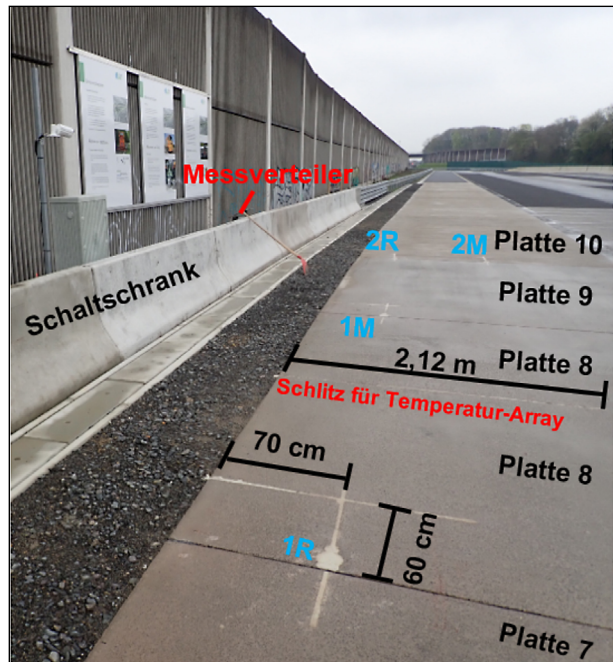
Sicht nach Norden auf dem Waschbetonabschnitt 40 des duraBAST
